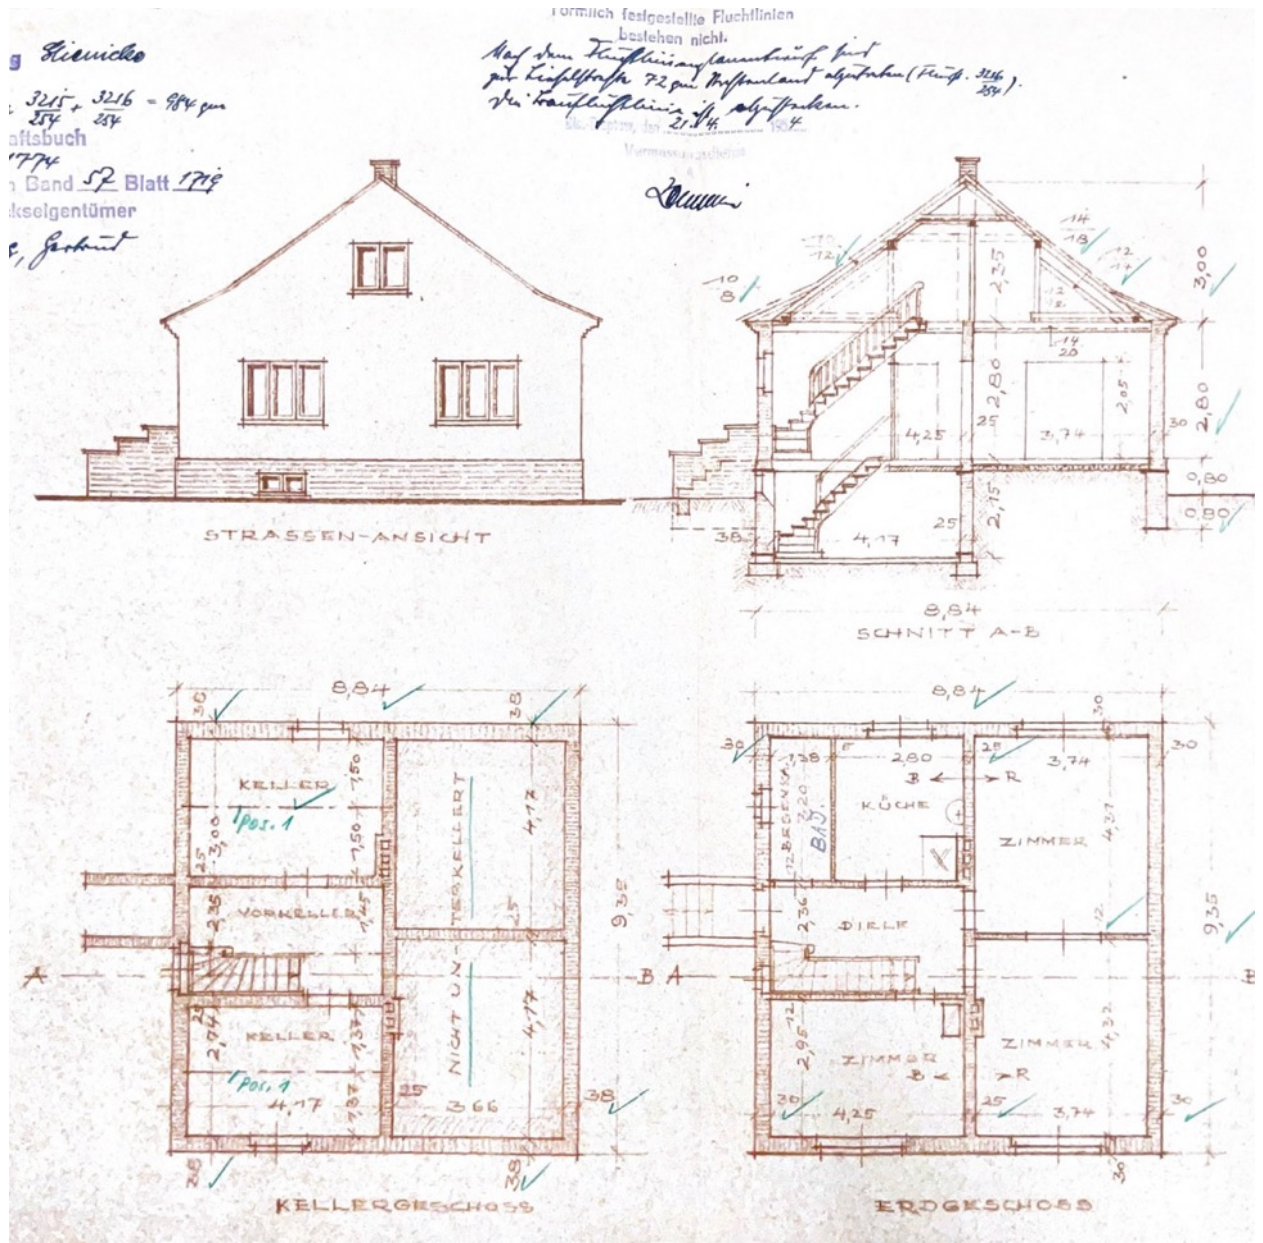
Bauzeitliche Pläne von 1954 zum Einfamilienhaus (damals: ohne Anbau, Windfang, Dachgeschossausbau)
